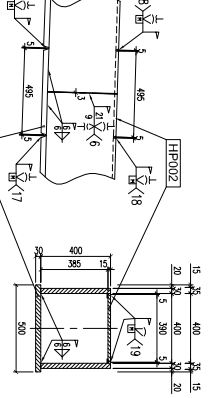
DETAIL MONTÁŽNÍHO STYKU DIAGONÁLA - HORNÍ PAS
